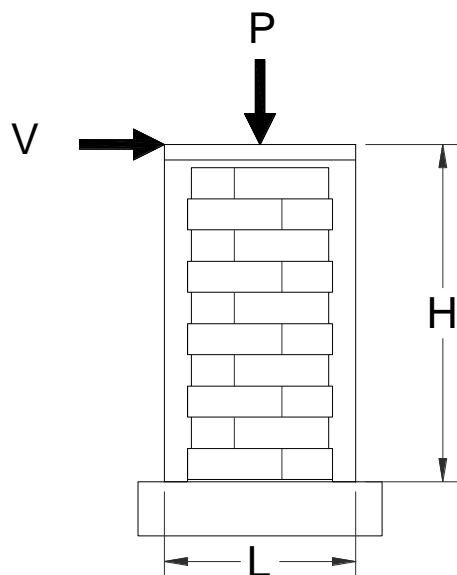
Muro confinado de sujeto a carga axial y lateral
